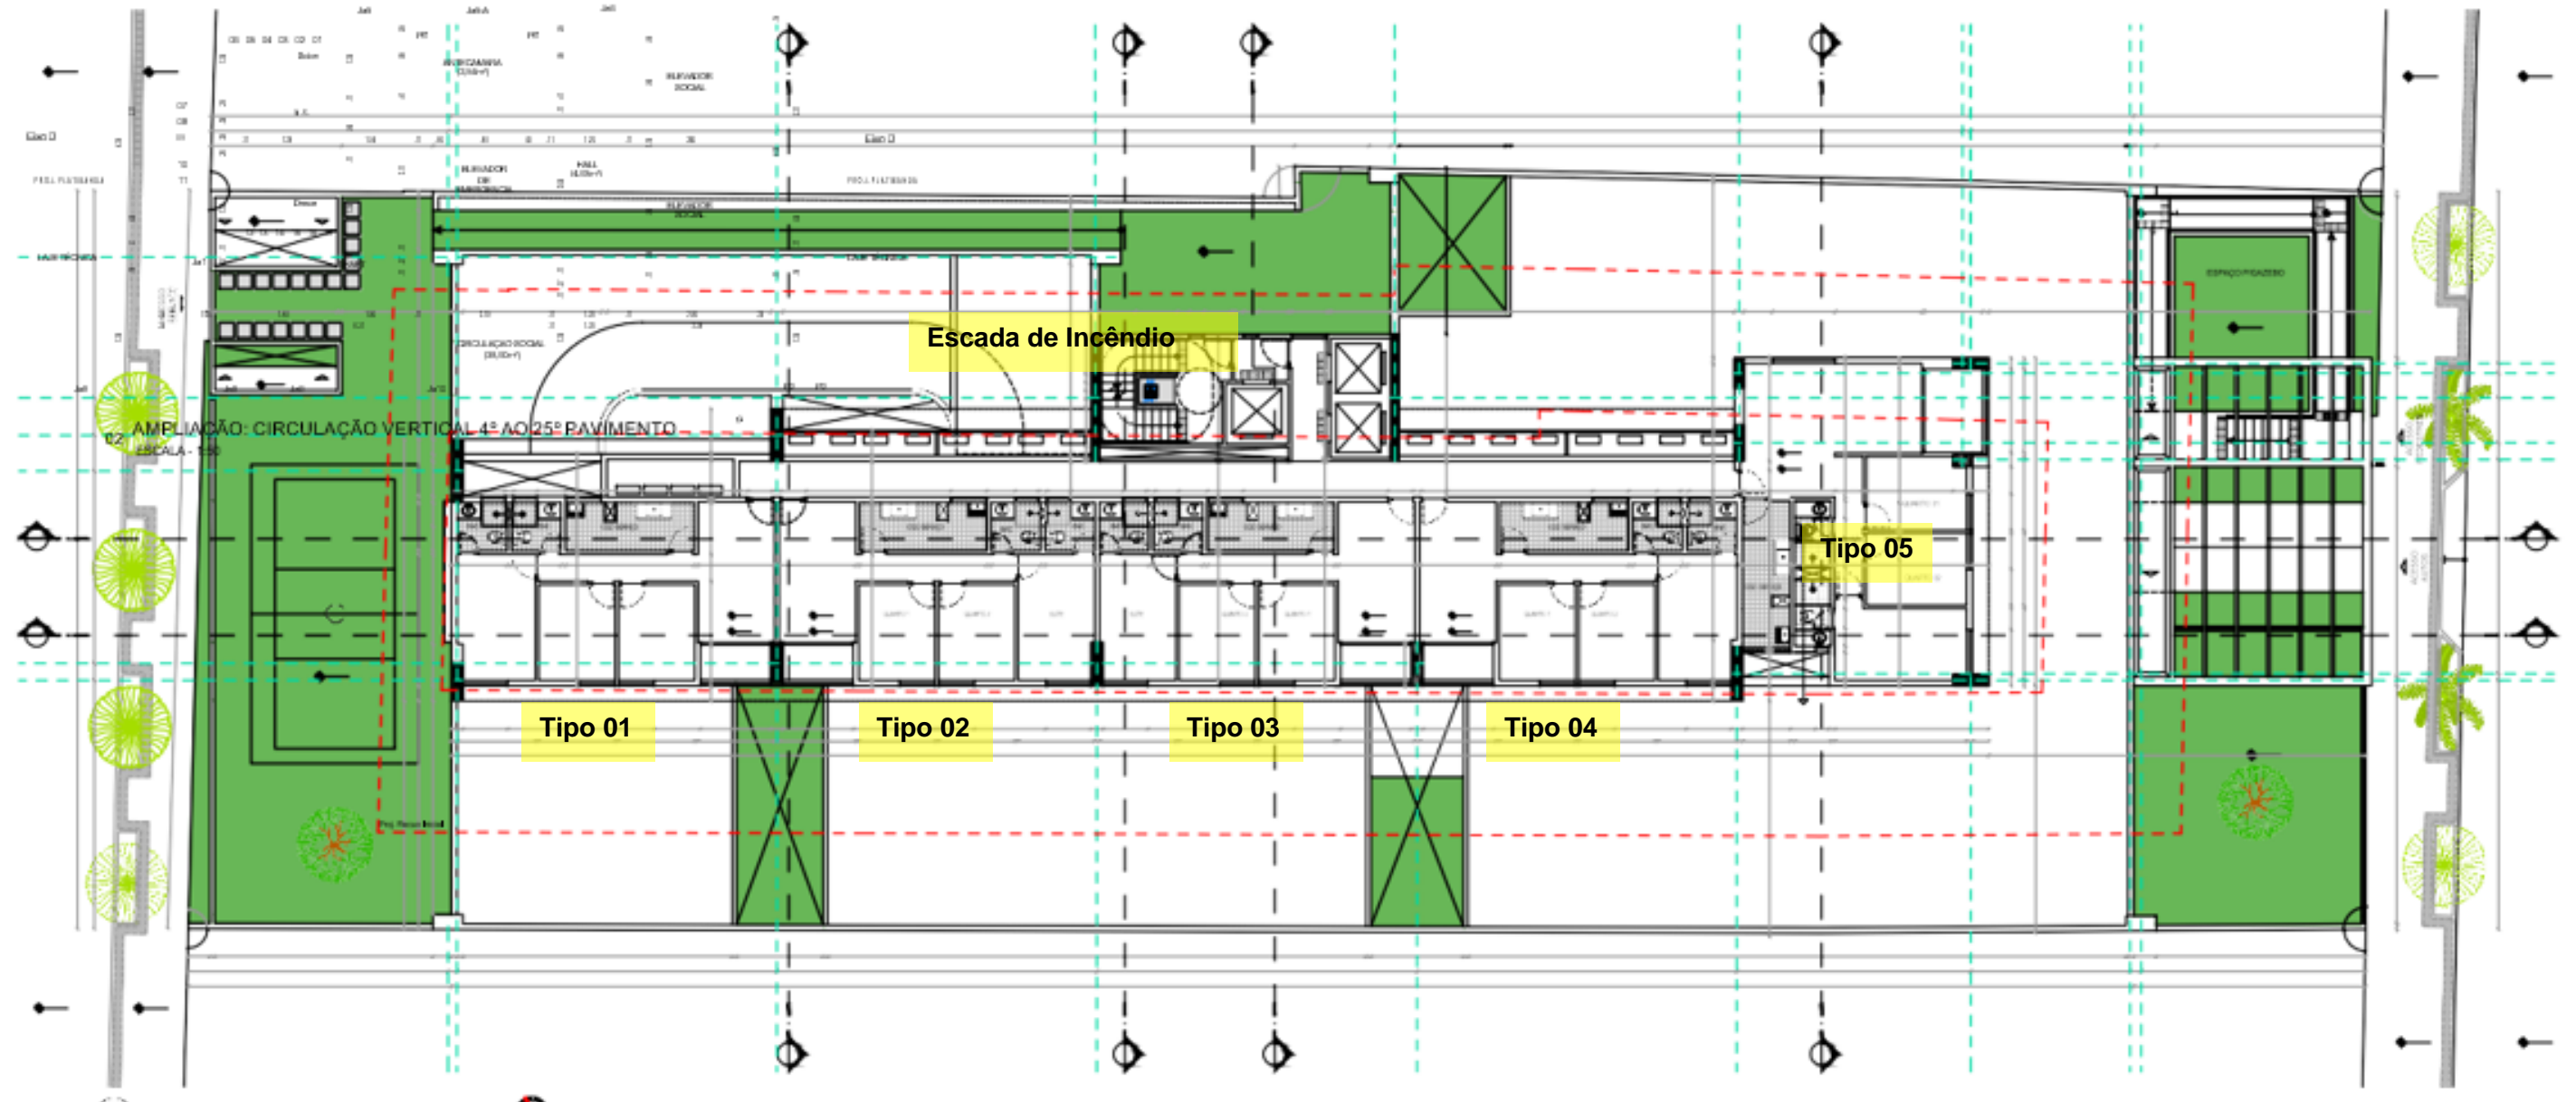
Planta Baixa 4º ao 25º Pavimento – Pavimento tipo – p06.13.
